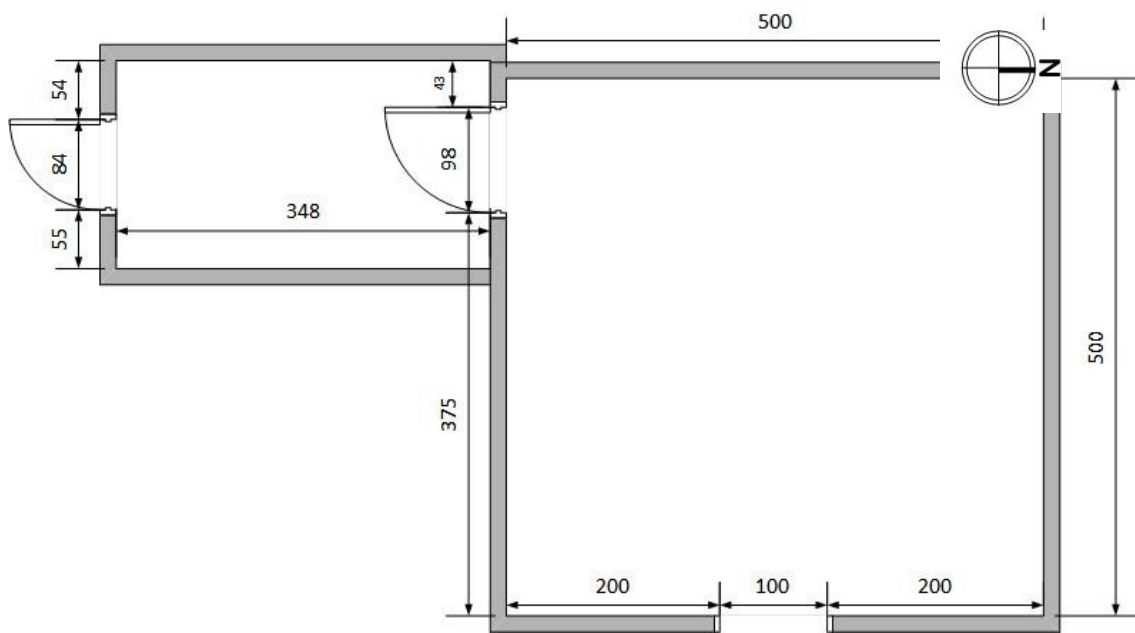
Grundriss Brandraum (eigene Darstellung, 2019)
